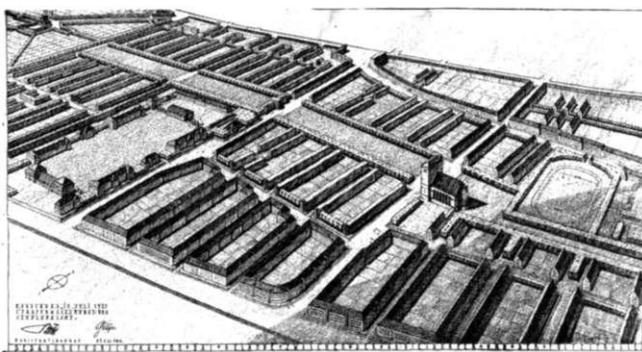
Bebauungsplan Dezember 1925 für das Gesamtgebiet
